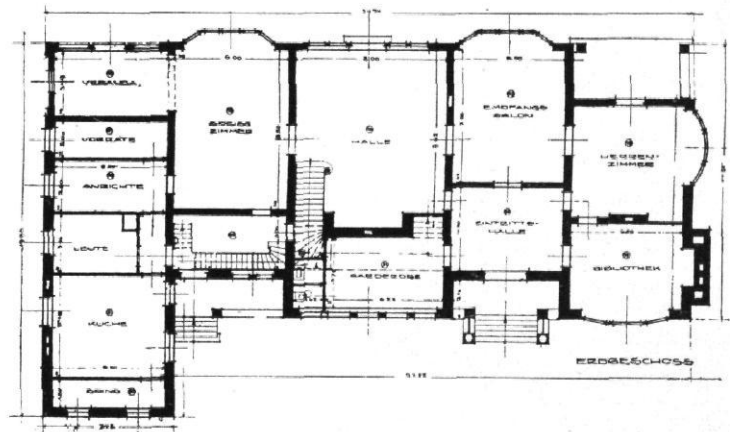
und 13 | Haus Dr. Fischer, Köln-Marienburg | Architekt: Paul Pott, Köln | Gartenansicht | Grundriß 1:400
